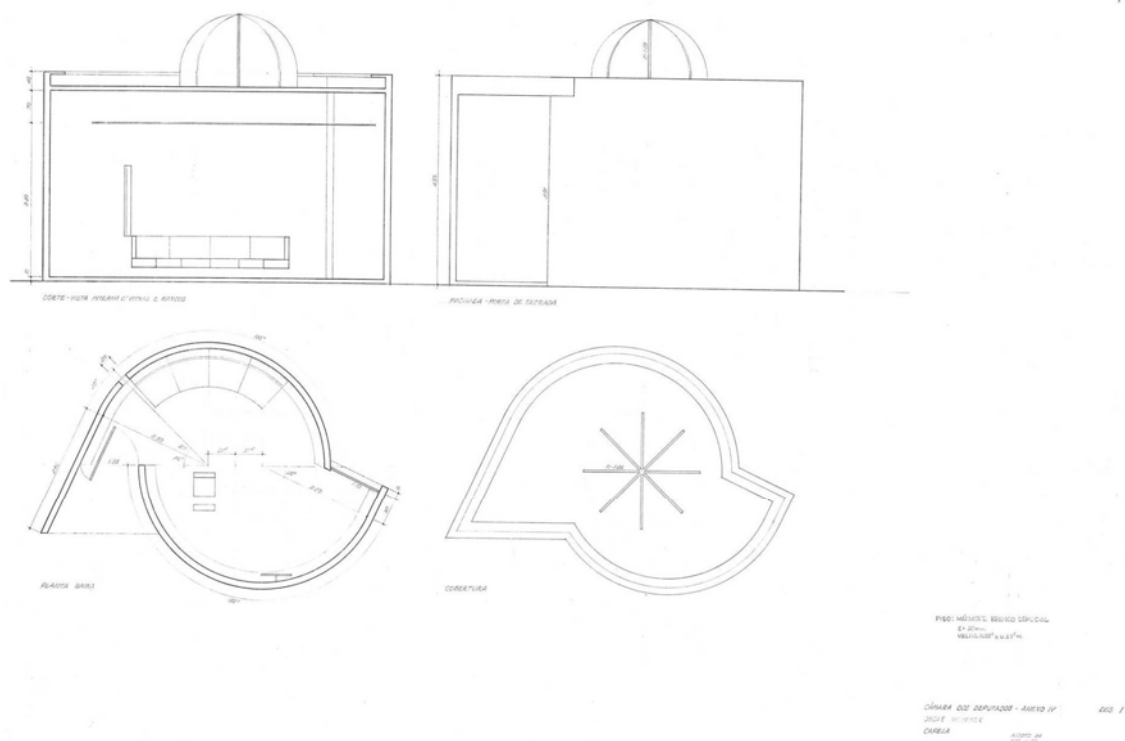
Planta Baixa, Corte, Fachada e Cobertura, 1994.
